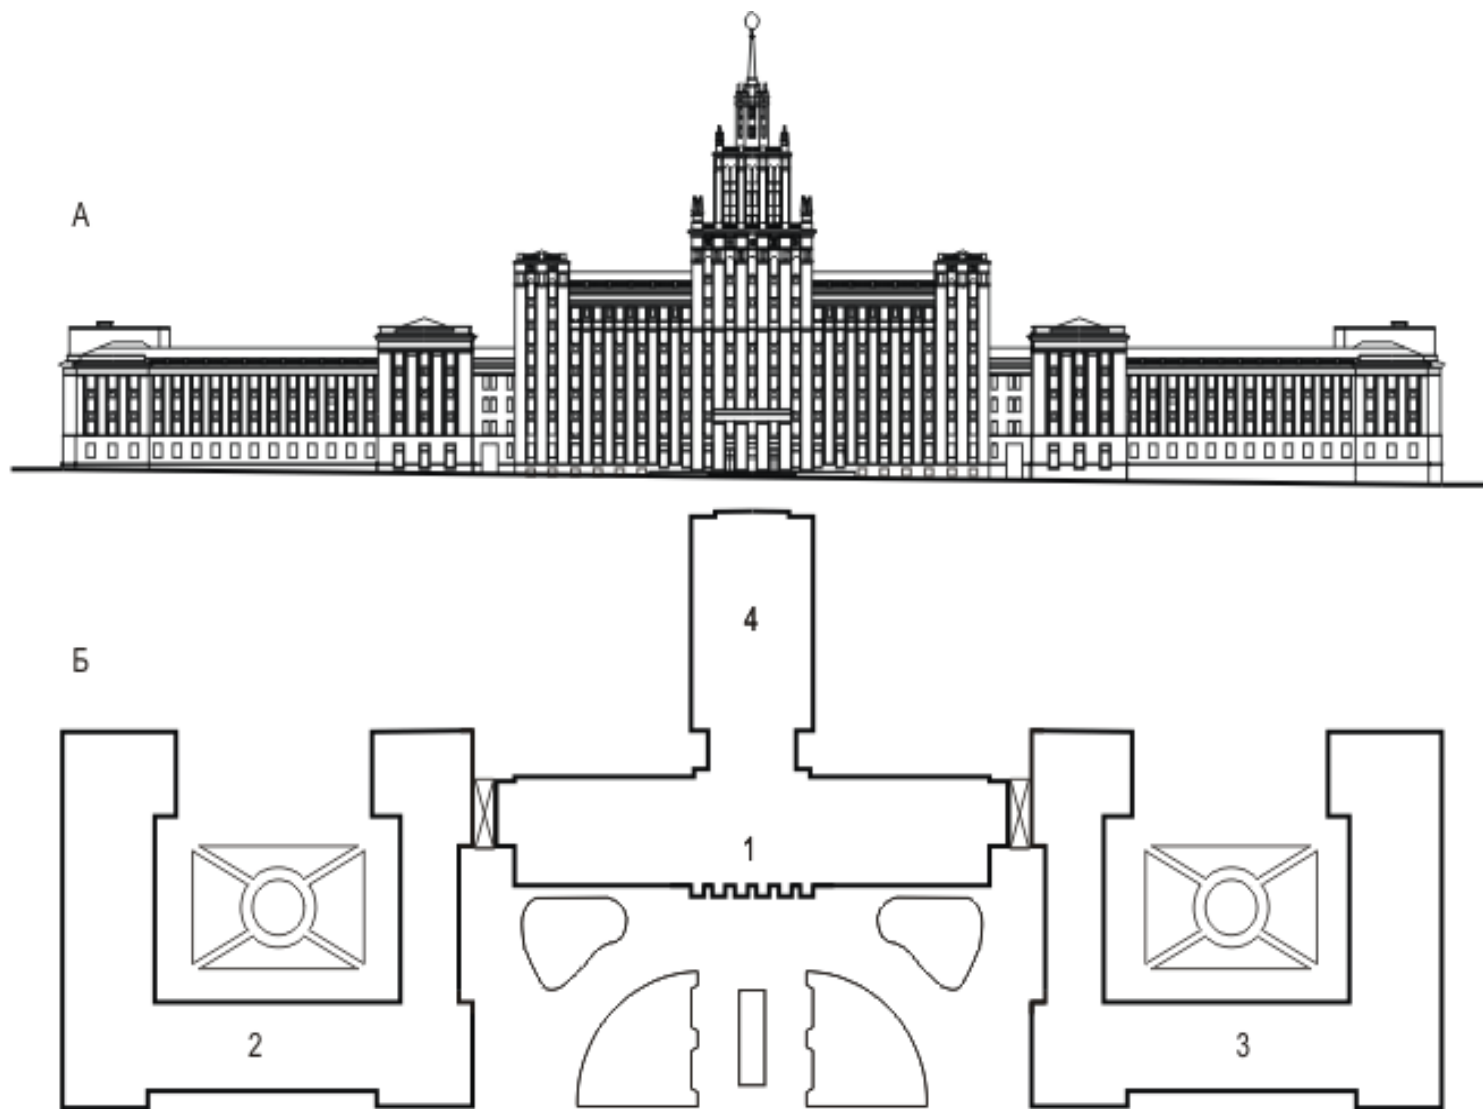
Проект фасада (А) и схема генплана (Б) главного корпуса университета по предварительному варианту с 7-этажной центральной частью, башней и шпилем: 1 – центральная часть; 2 – западное крыло; 3 – восточное крыло; 4 – пристроенный блок библиотеки и актового зала (1995 г.)
